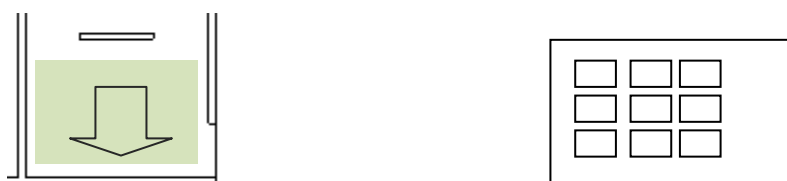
Módulo Área Externa e Implantação. Planta baixa e elevação esquemática da parede 01.
